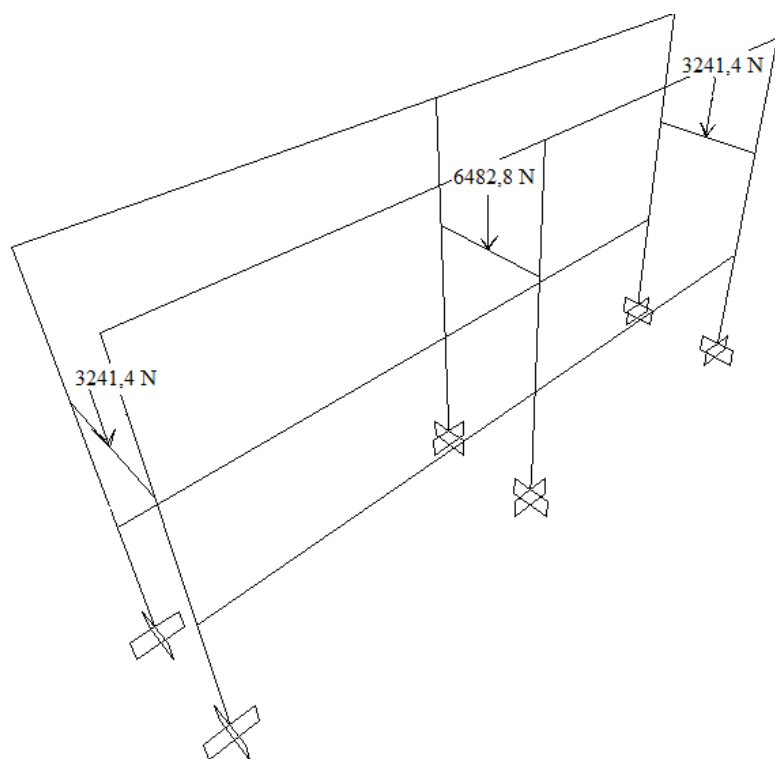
Diagrama de cargas sobre la estructura. Fuente. SAP2000.
